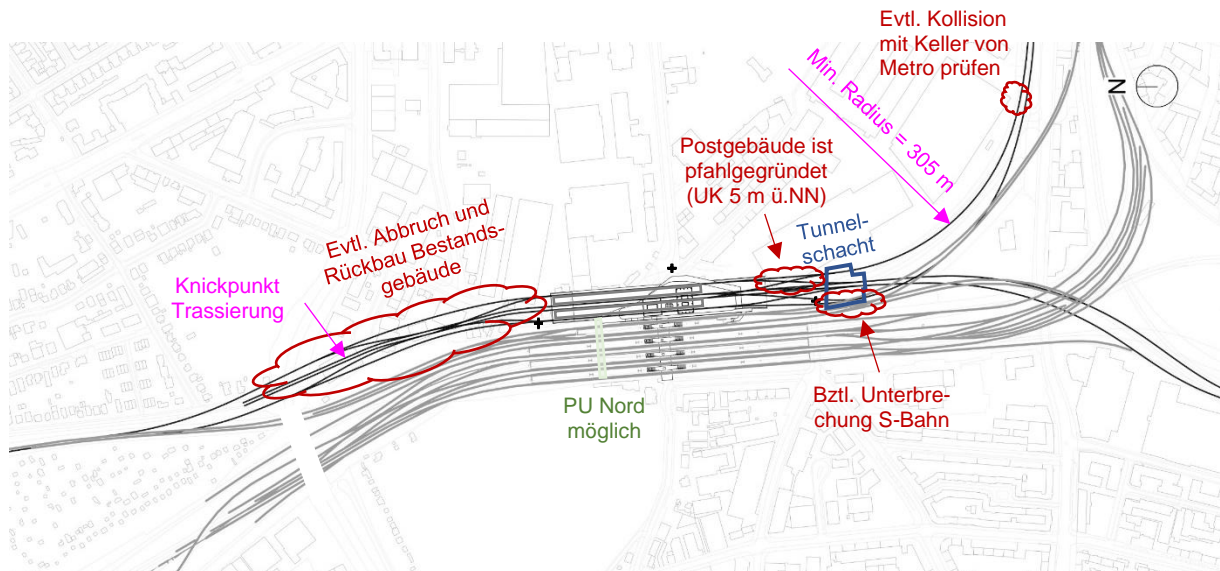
HP Altona Diebsteich IIIa - Lageplan mit Konfliktpunkten
